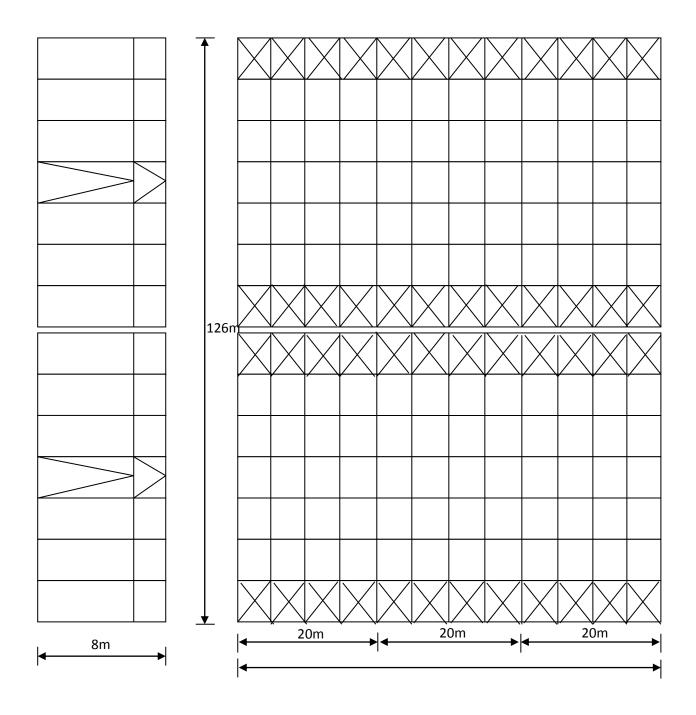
La vue en plan de la Stabilité horizontale et verticale
